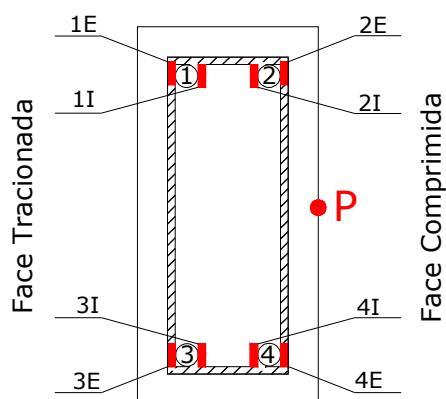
Posição dos extensômetros colados na armadura longitudinal
